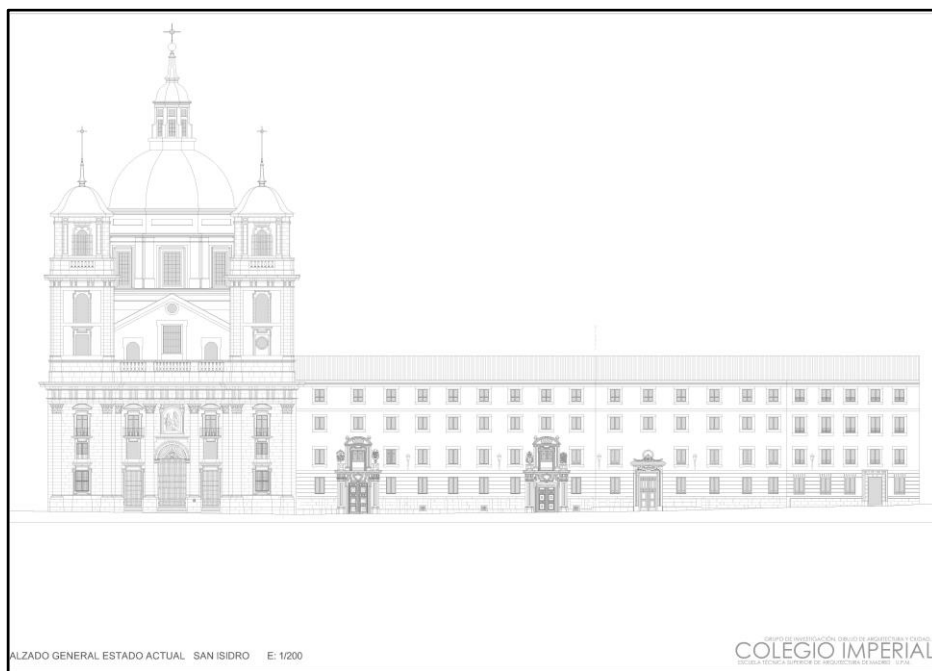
Concatedral e Instituto de San Isidro: alzado a las calles de Toledo y de los Estudios.
